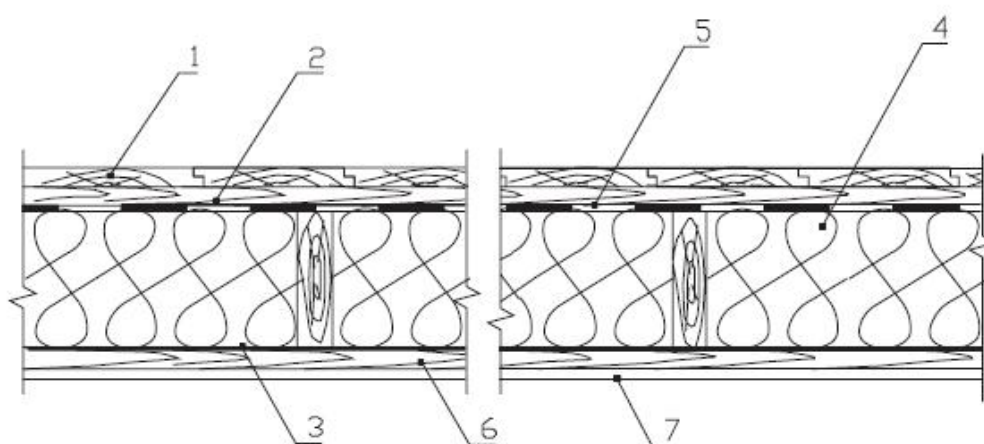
Разрез каркасной стены с теплоизоляционным слоем из плит марки "ТЕРМО" в качестве среднего слоя каркасной конструкции
